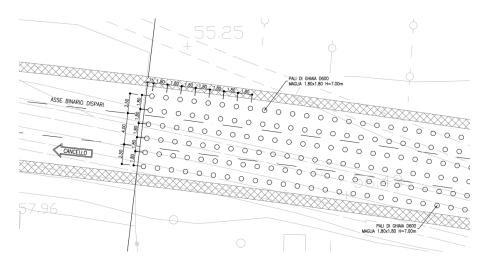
Stralcio planimetrico dell'intervento di consolidazione
